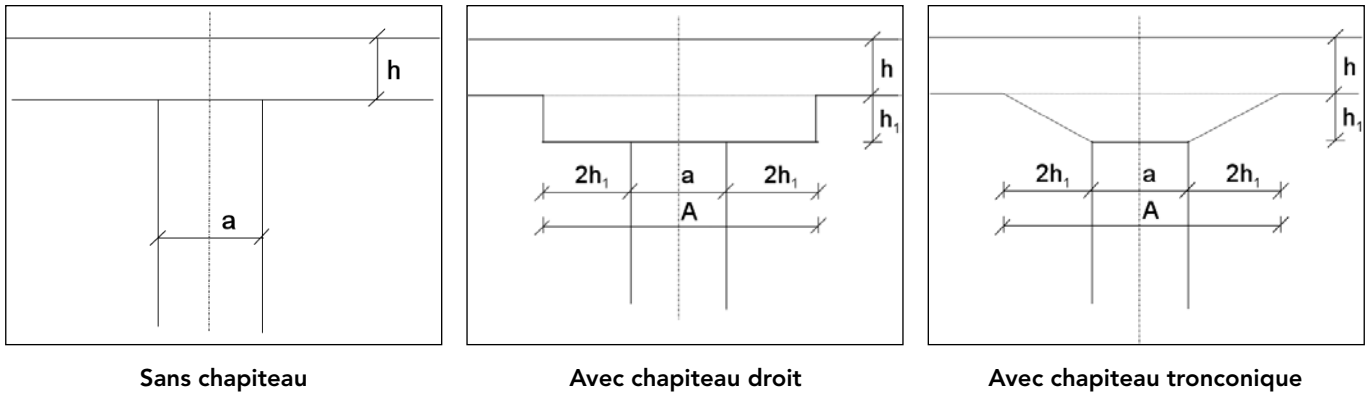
Plancher-dalle avec et sans chapiteau
